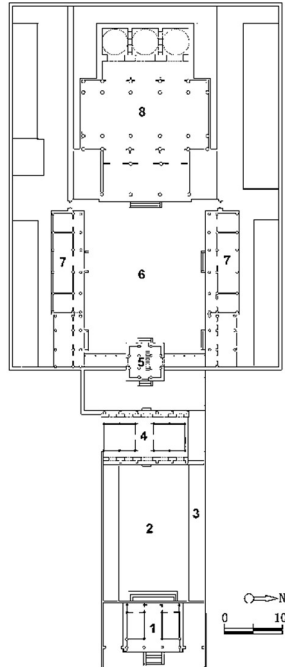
المسقط الأفقي لمسجد هوايشنغ سي
